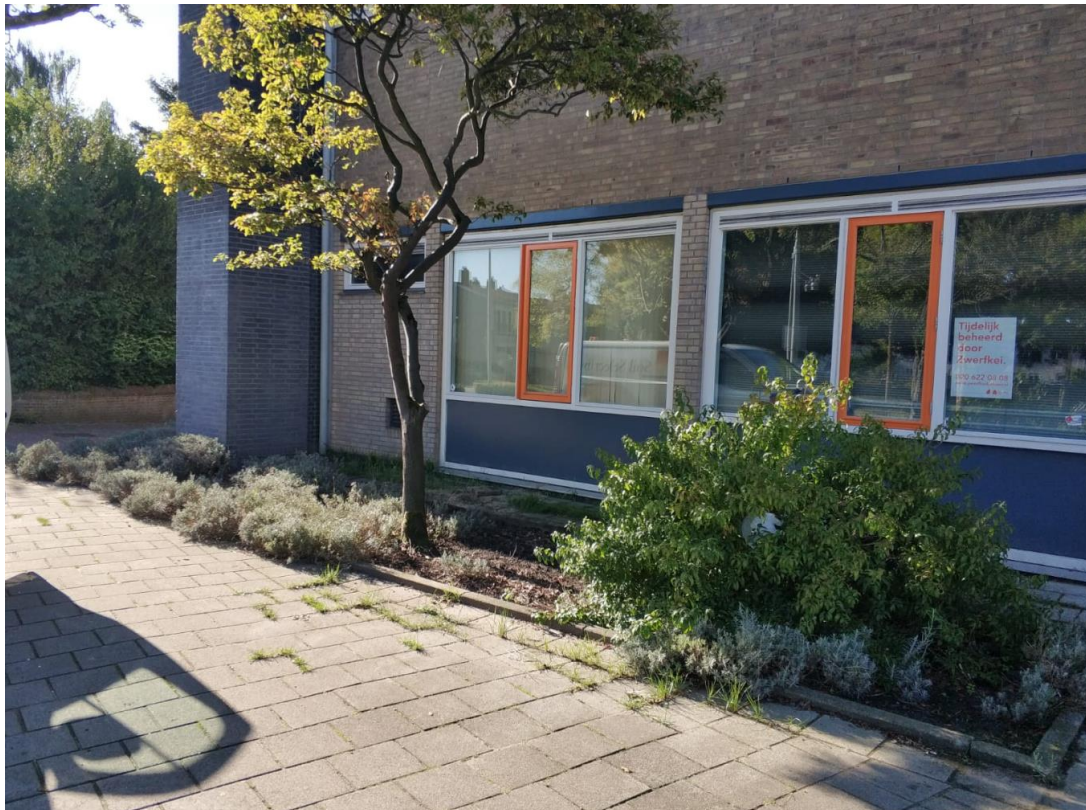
Situatie aan de voorzijde van het pand (boring 06).
